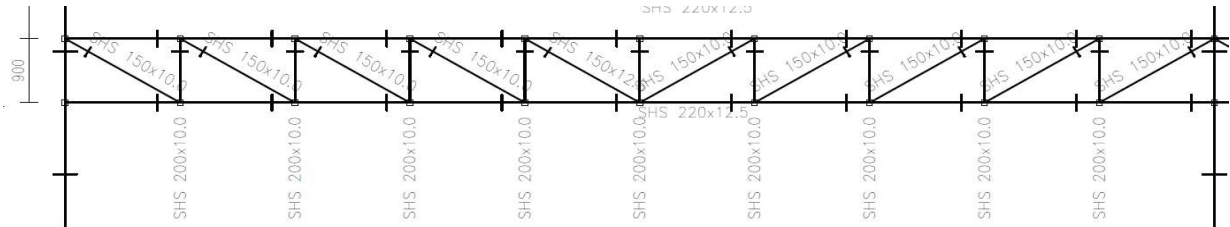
Detalle constructivo de la viga Pratt. Fuente propia.
